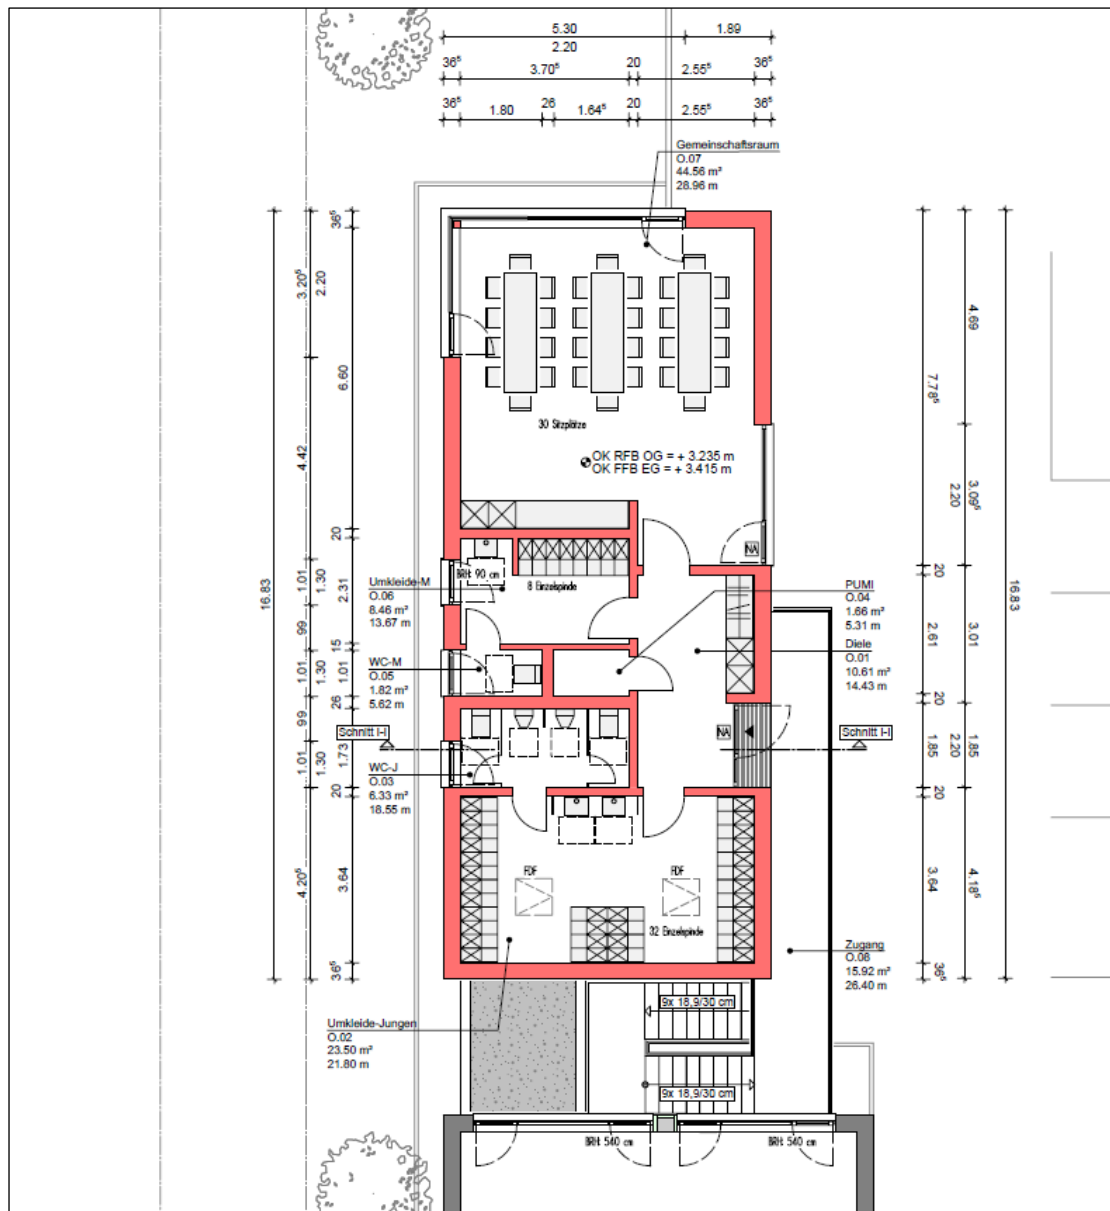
Grundriss des geplanten Anbaus, Obergeschoss. David Kölsch, freier Architekt, 04.03.2023
